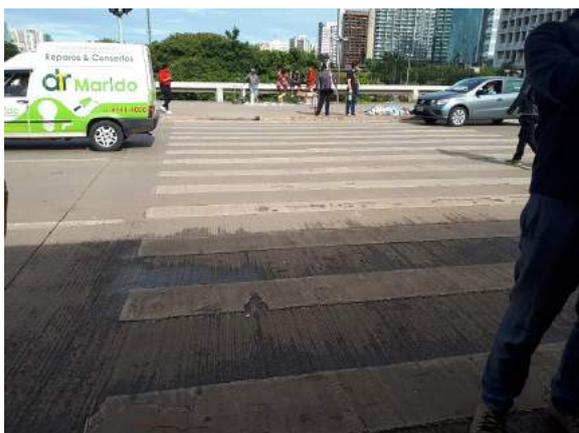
Vista da faixa de travessia ao longo da via oeste da plataforma;
